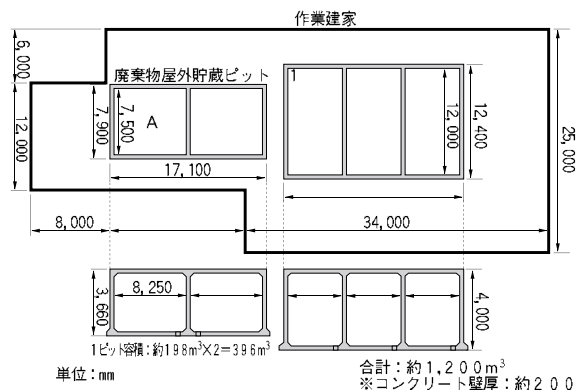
廃棄物屋外貯蔵ピット平面図及び断面図
